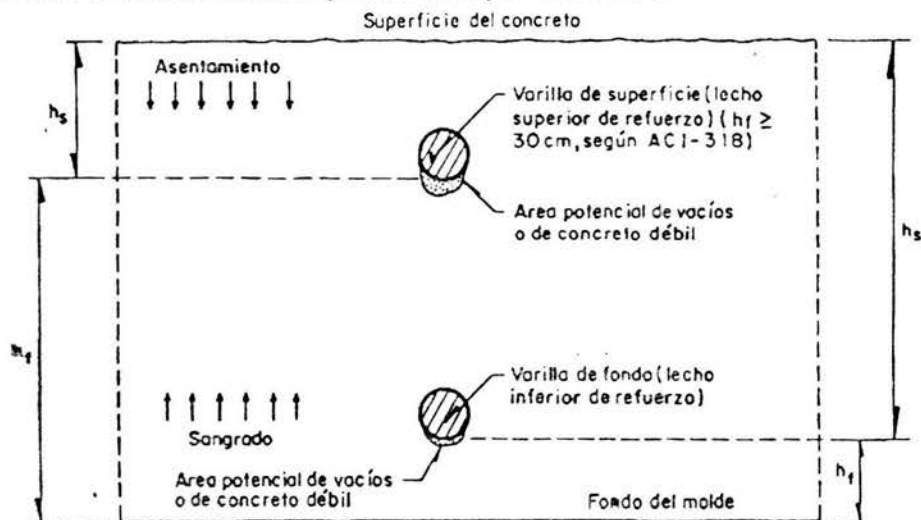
Formación de vacíos o de concreto débil bajo las varillas coladas en posición horizontal a diferente profundidad.
